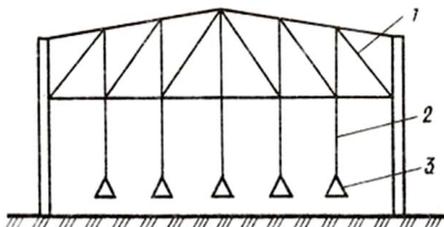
Схема приложения нагрузки к нижнему поясу фермы
